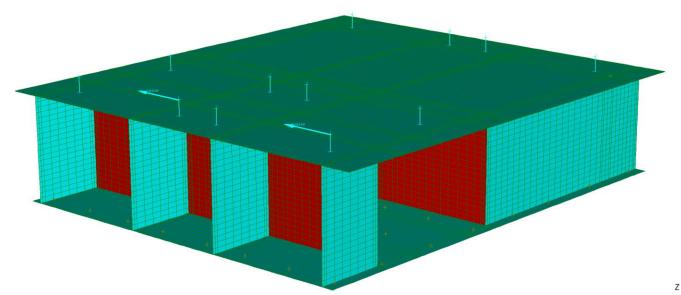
Serpeggio - Q1 serpeggio testa
